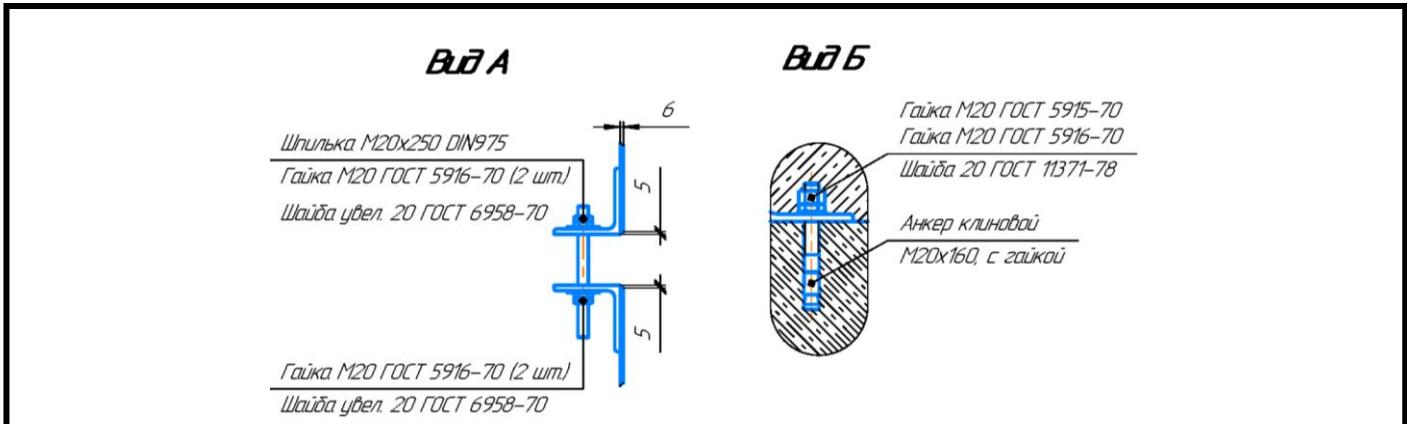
Способ крепления горизонтального корпуса удерживающими лентами производства ООО «АКО»
